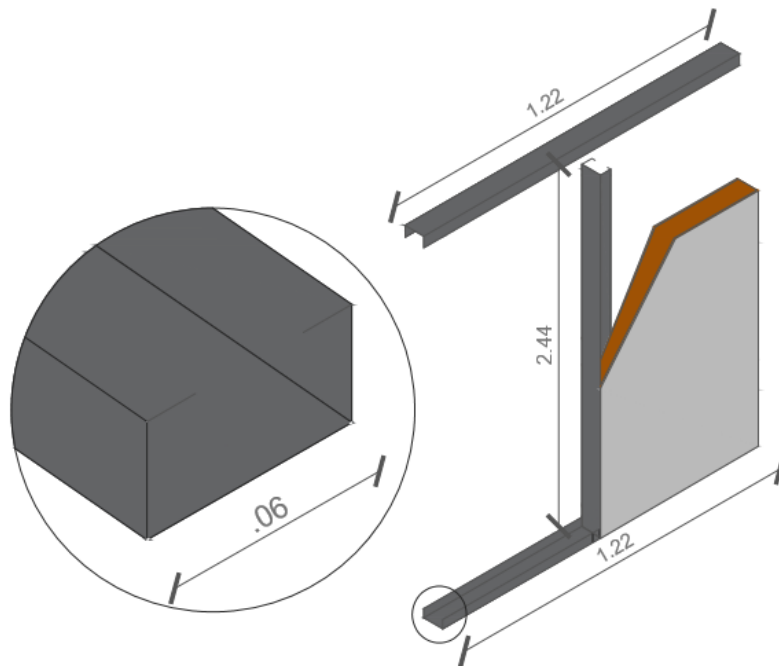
Estructura de los prototipos en acero galvanizado para base 6 y canal base 6. Fuente: Elaboración propia (2016)
